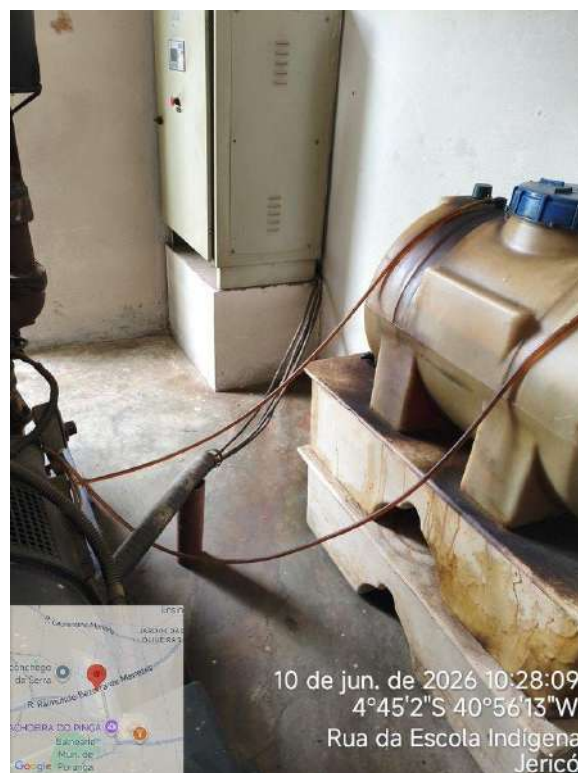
EEE-01: cabeamento sem isolamento de proteção; instalações obstruindo a passagem.
